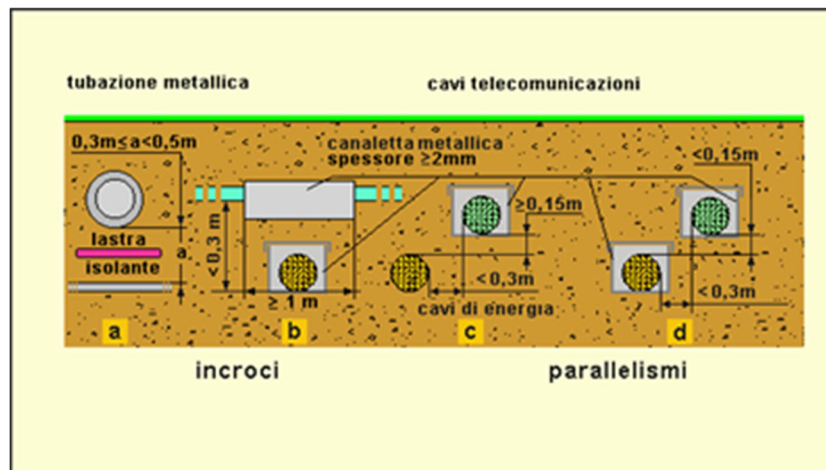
Precauzioni in caso di mancato rispetto delle distanze minime
